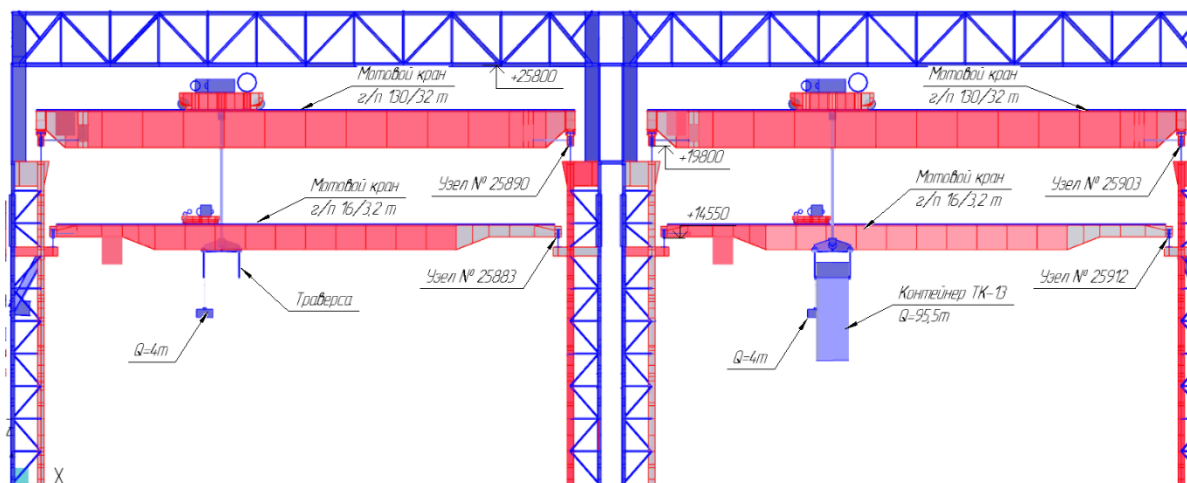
Промышленное здание с крановыми нагрузками: а – конечно-элементная
